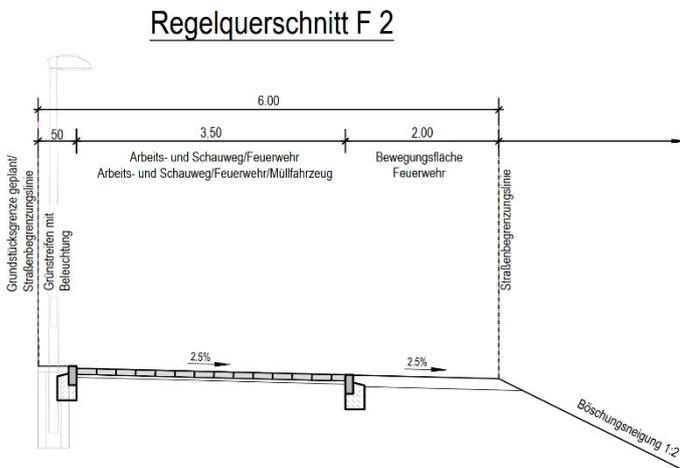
Arbeits- und Schauweg mit Feuerwehraufstell- und -bewegungsfläche
